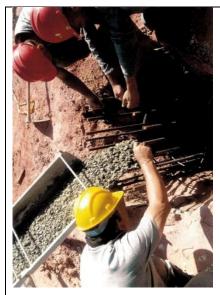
Lançamento de concreto para execução de uma estaca. Foto da época da obra.
